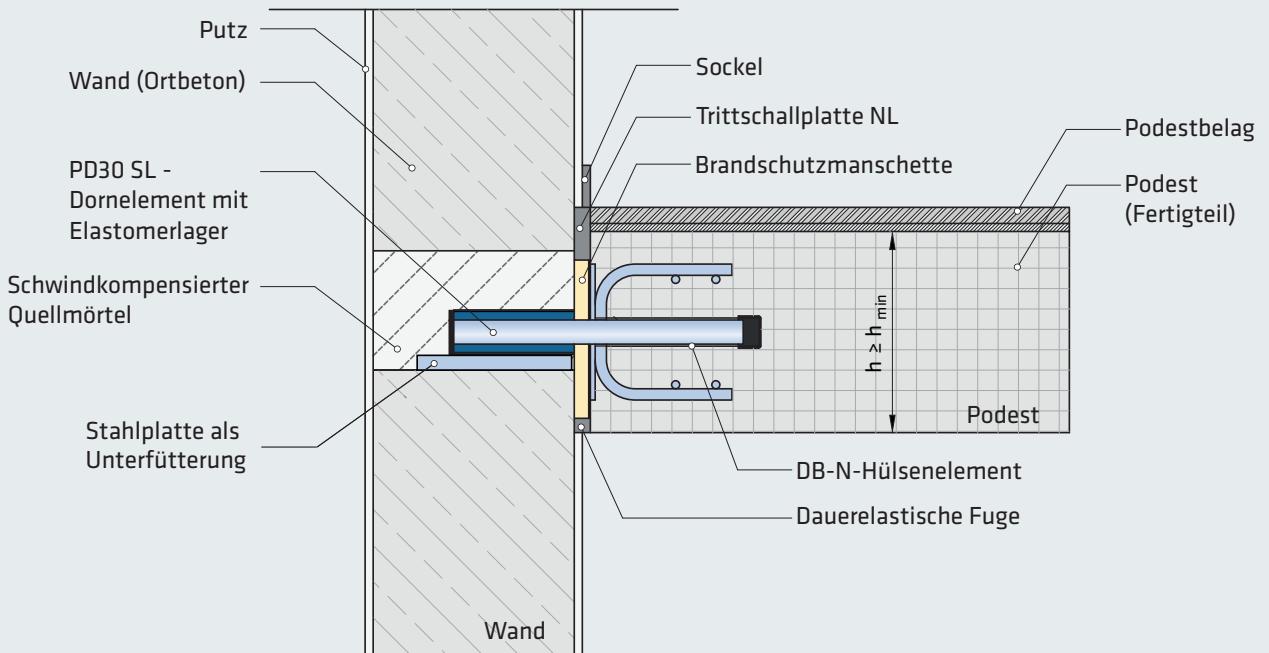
Anschluss Fertigteilpodest mit nachträglicher Montage in Wandaussparung
